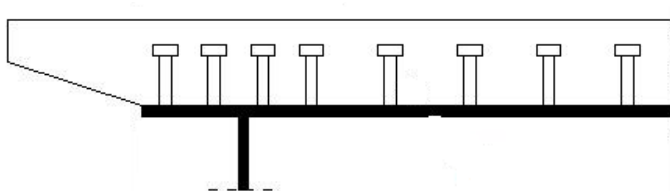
Сталежелезобетонная плита с нижней листовой обшивкой
